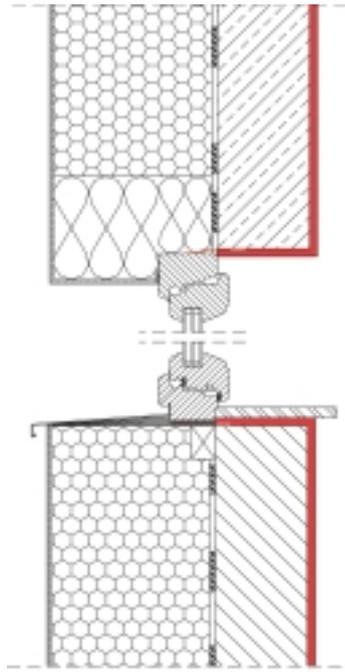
Optimierte Einbausituation: Fenster mit Einbaukonsole X aus Holz oder Polyurethan-Recyclingmaterial in Massivbauwand mit Wärmedämmverbundsystem. Das Fenster wird vor dem Mauerwerk angeordnet und damit ausreichend weit in die Dämmebene gerückt, siehe auch Abbildung 67 und Abbildung 84. In Laibung und Sturz kann der Rahmen überdämmt werden, einige Hersteller bieten inzwischen auch abgeschrägte Dämmkeile für die Laibung an, siehe Abbildung 69.
